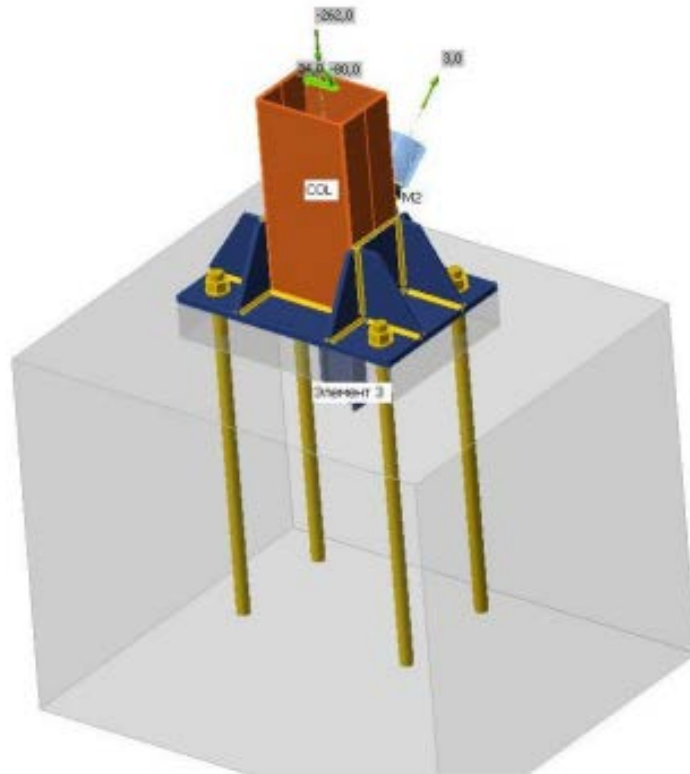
Модель з'єднання колони із фундаментом
